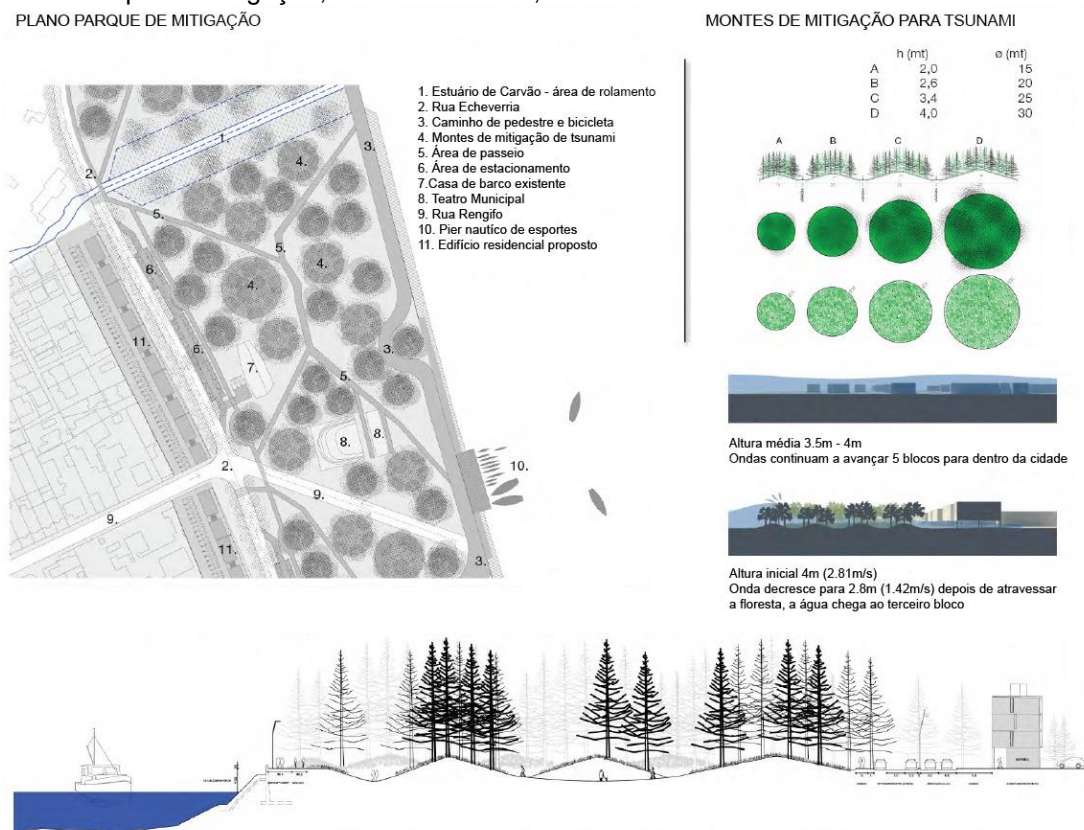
PLANO ANTI MAREMOTO de PRES Constitución.
